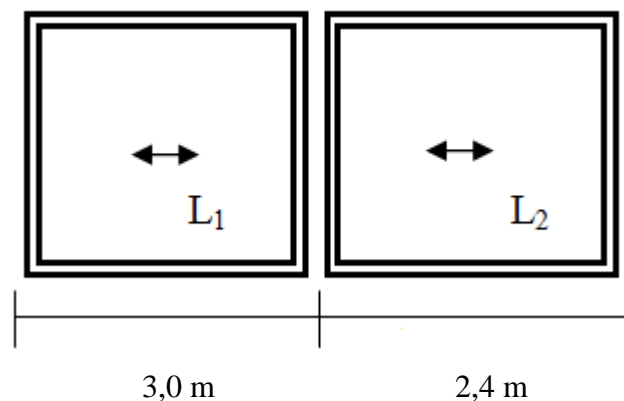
Diagrama das Lajes (Autora, 2017)
